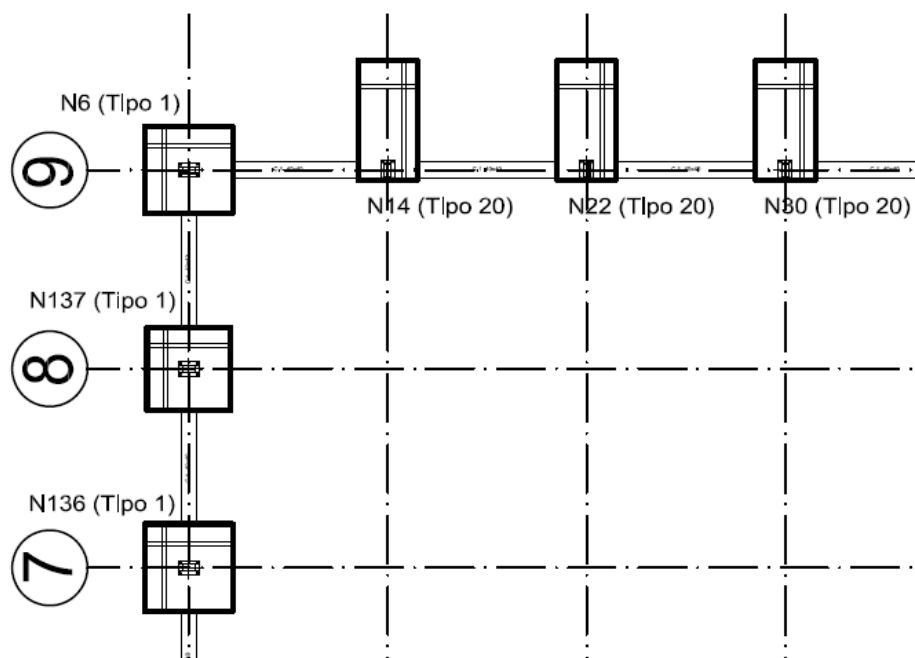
Planta de cimentaciones (Plano 4). Ampliación a nodos seleccionados.
